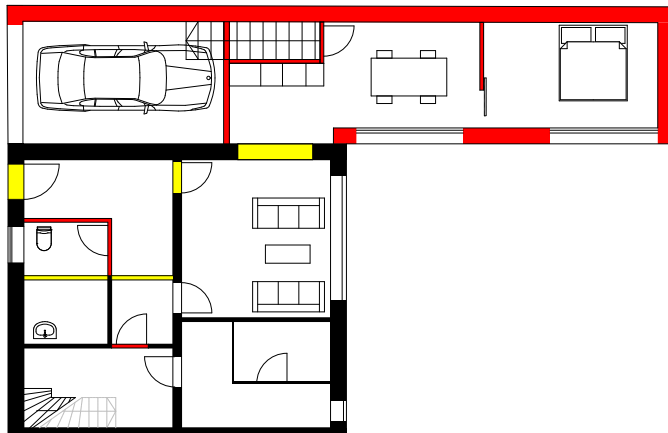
Änderungen im Grundriss des Bestands
